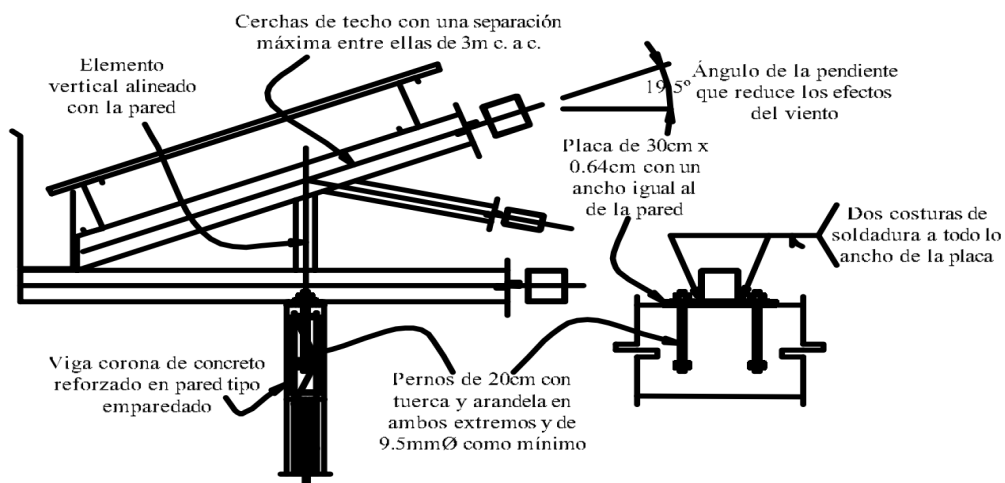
Detalle de apoyo de viga de techo en pared delgada a doble forro
